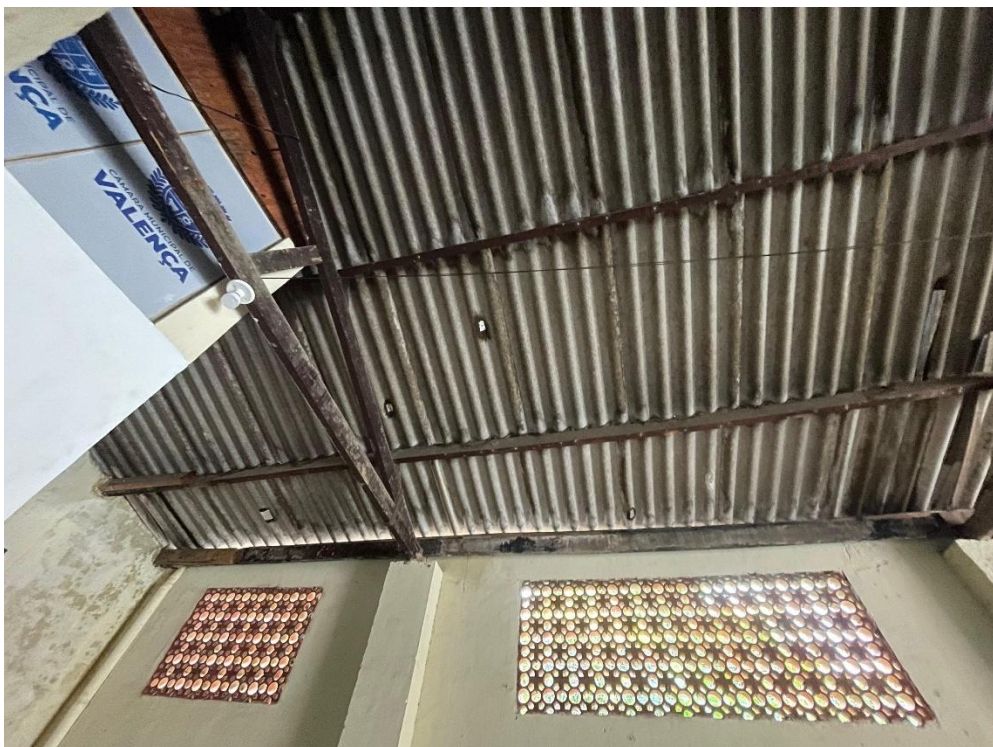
06/01/2026 – Vista da parte interna do telhado e área interna do galpão. Madeiramento e telhas com manchas de umidade e infiltração. Rachaduras e buracos nas telhas e fiação elétrica exposta. Pintura manchada e descascando.
